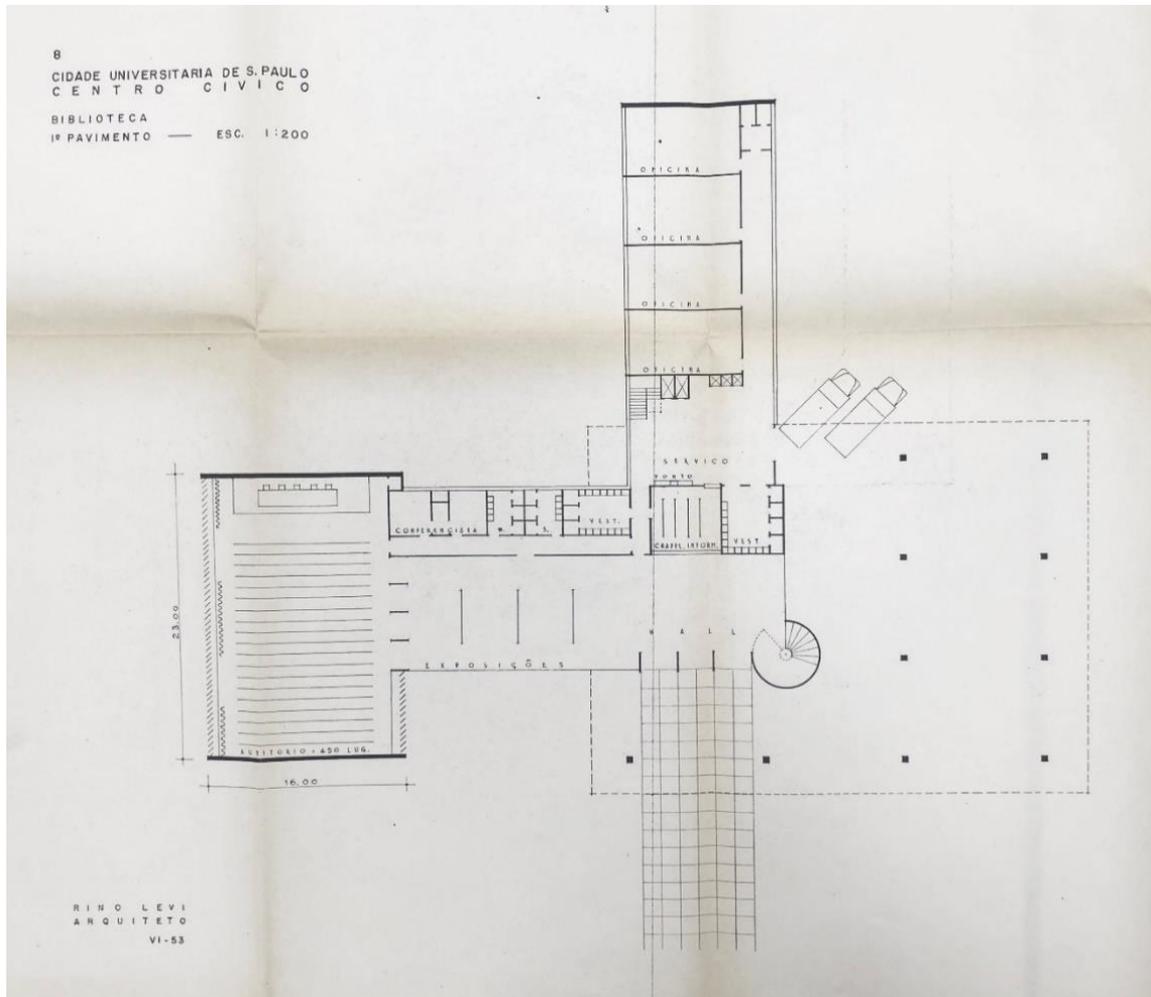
Planta do térreo (1º pavimento) do edifício da Biblioteca Central. Fonte: Arquivo FAU USP
